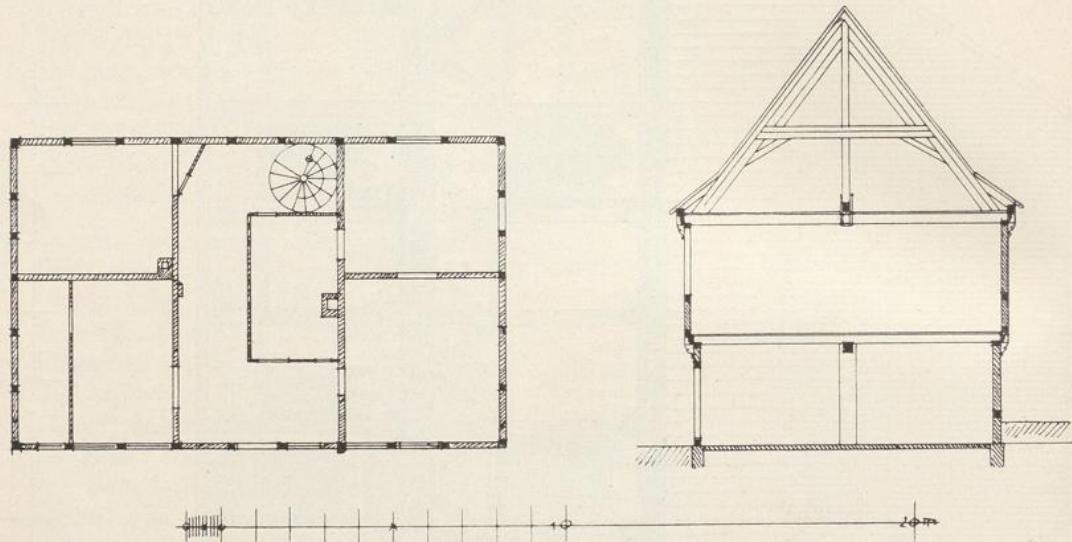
Am Kreideberge 7; Grundriss und Schnitt.
